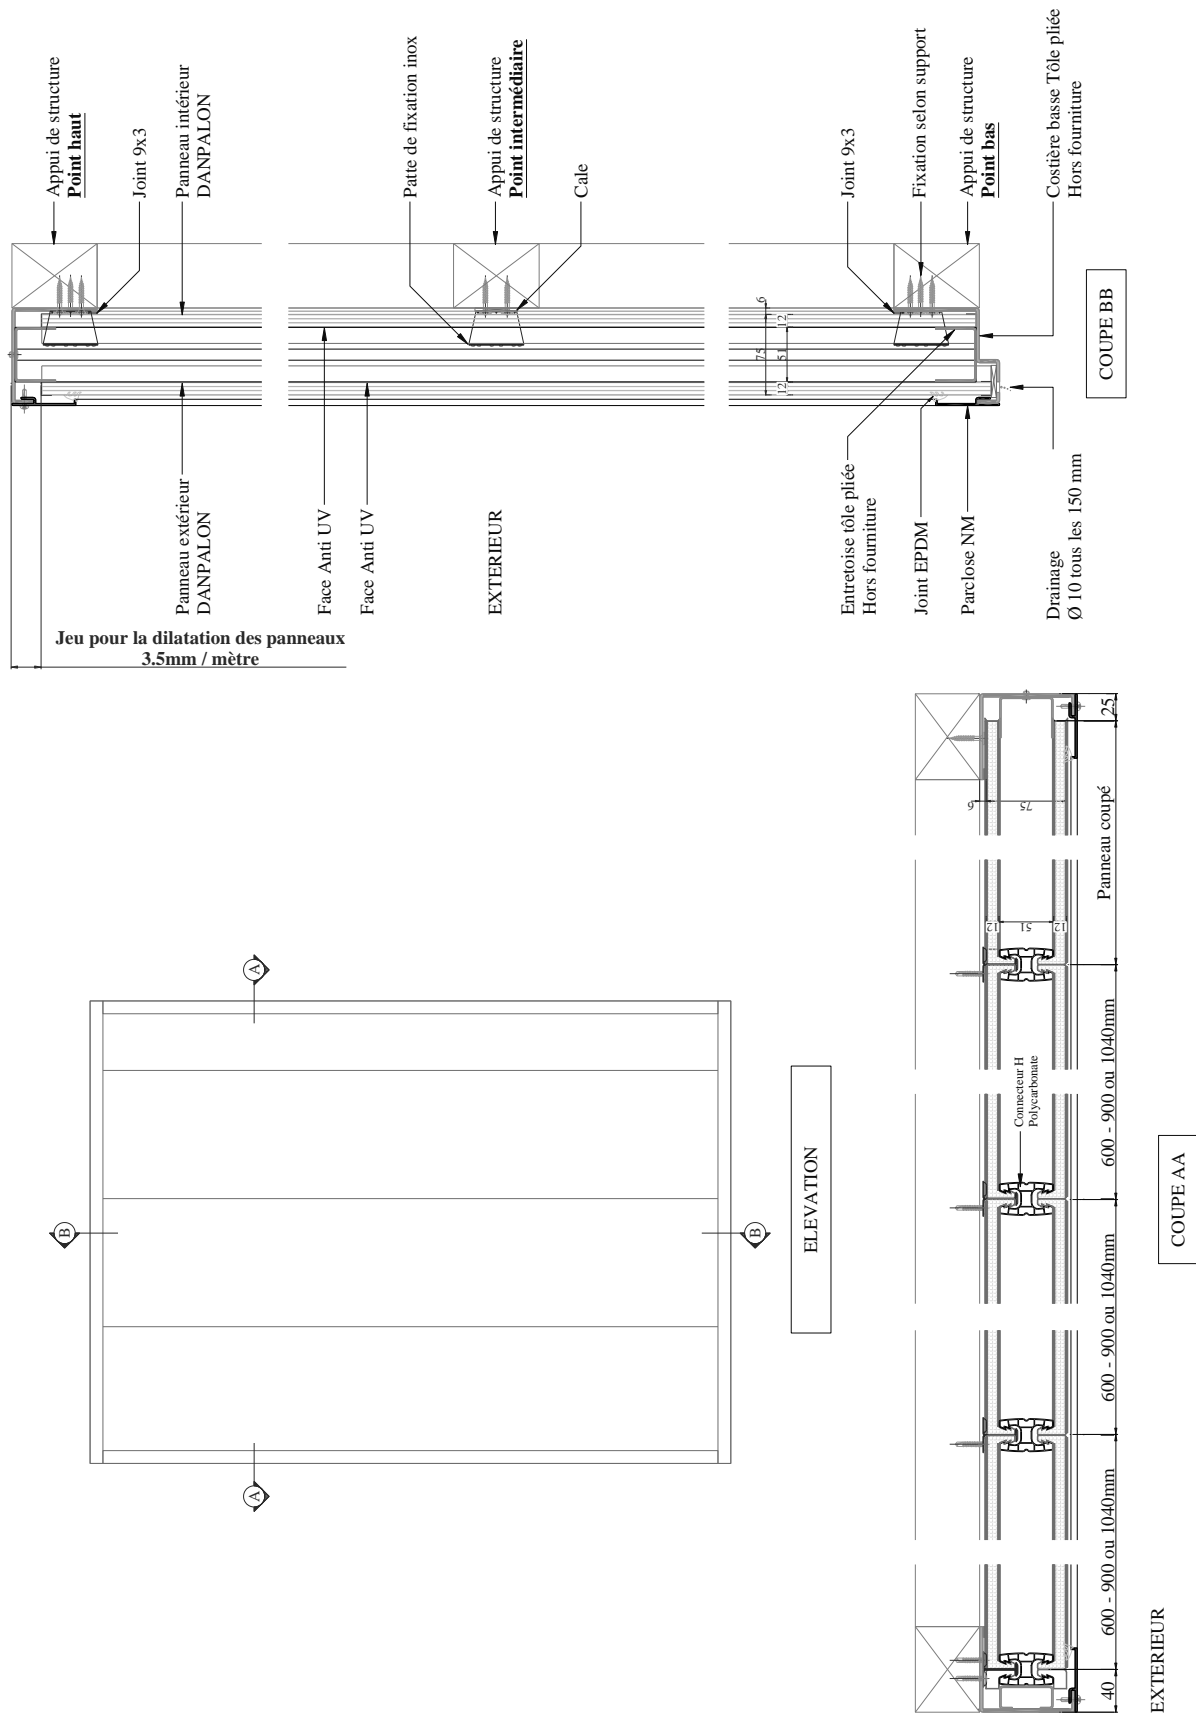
Coupe longitudinale et transversale sur connecteur H aluminium – système DANPATHERM
